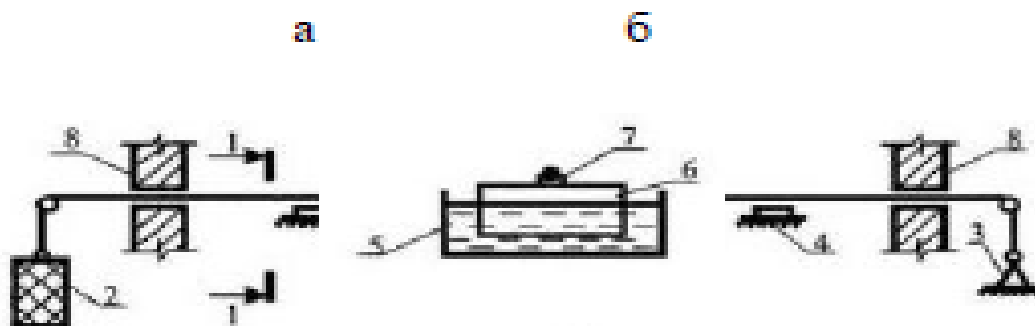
Конструктивная схема метода натянутой нити для определения горизонтальных смещений обследуемых строительных объектов: а – общая схема; б - схема плавающих опор; 1- стальная проволока; 2 -натягивающий груз; 3 - неподвижная опора; 4 - плавающая опора; 5 -ванночки; 6 - поплавок; 7 - вилка фиксатора проволоки; 8 - ограждающие конструкции объекта
